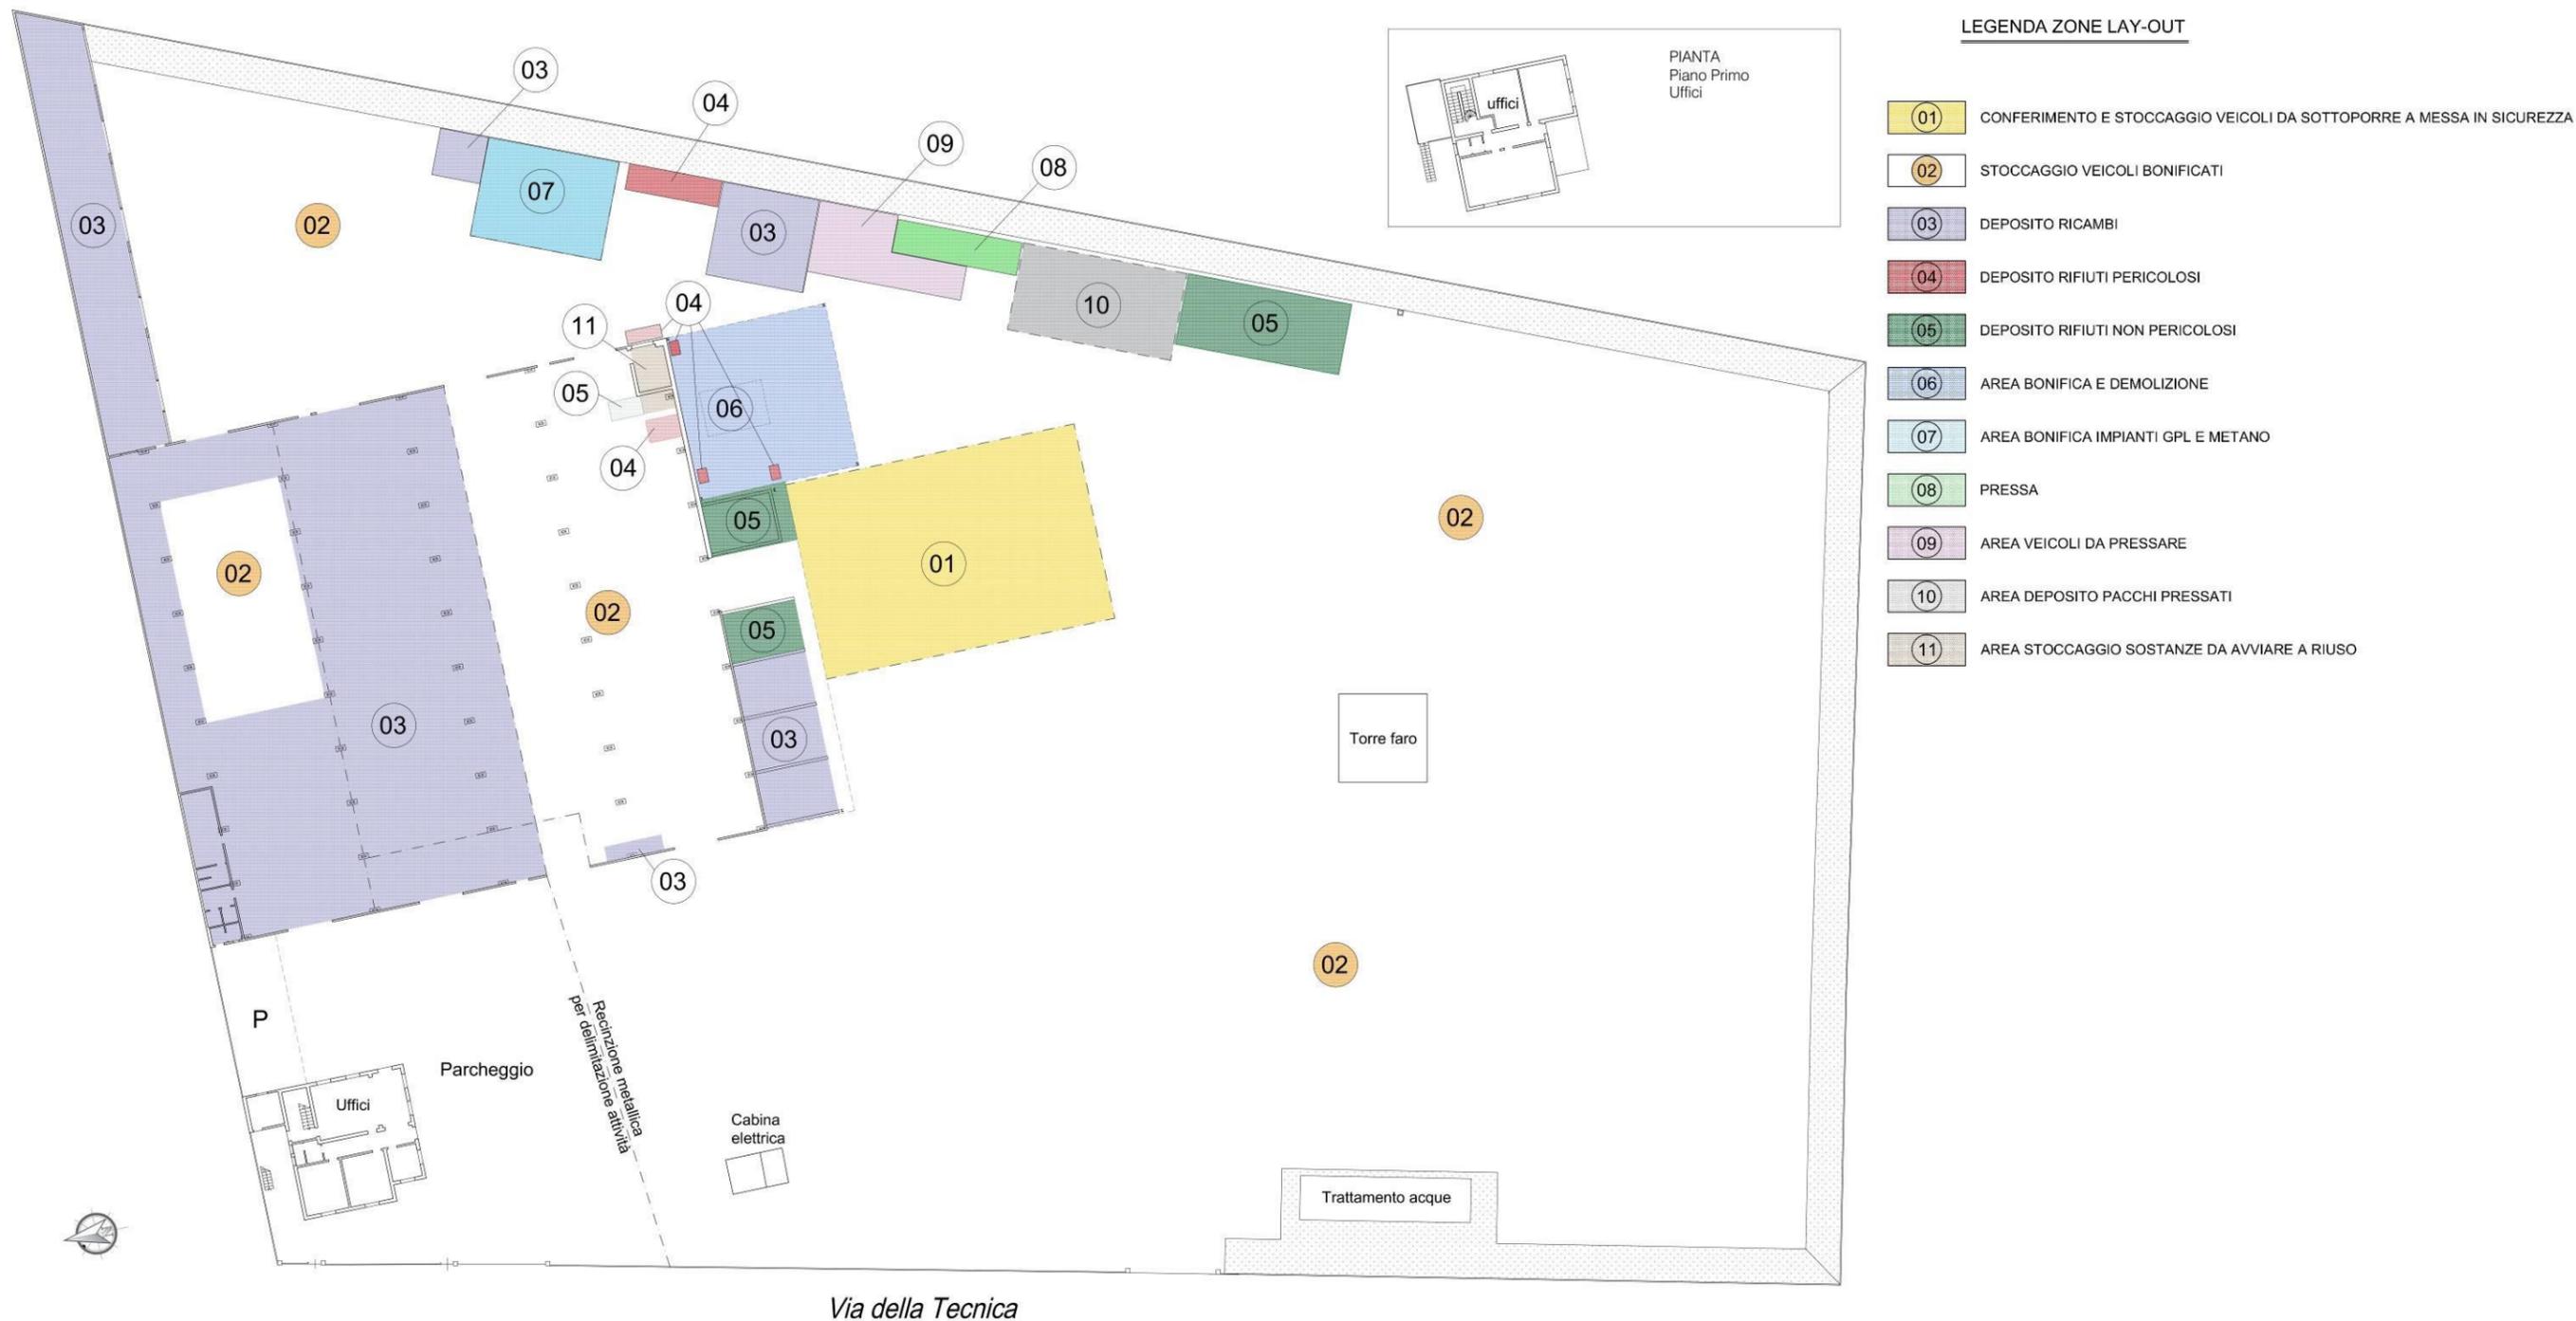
Planimetria layout organizzativo dell’impianto autorizzato
